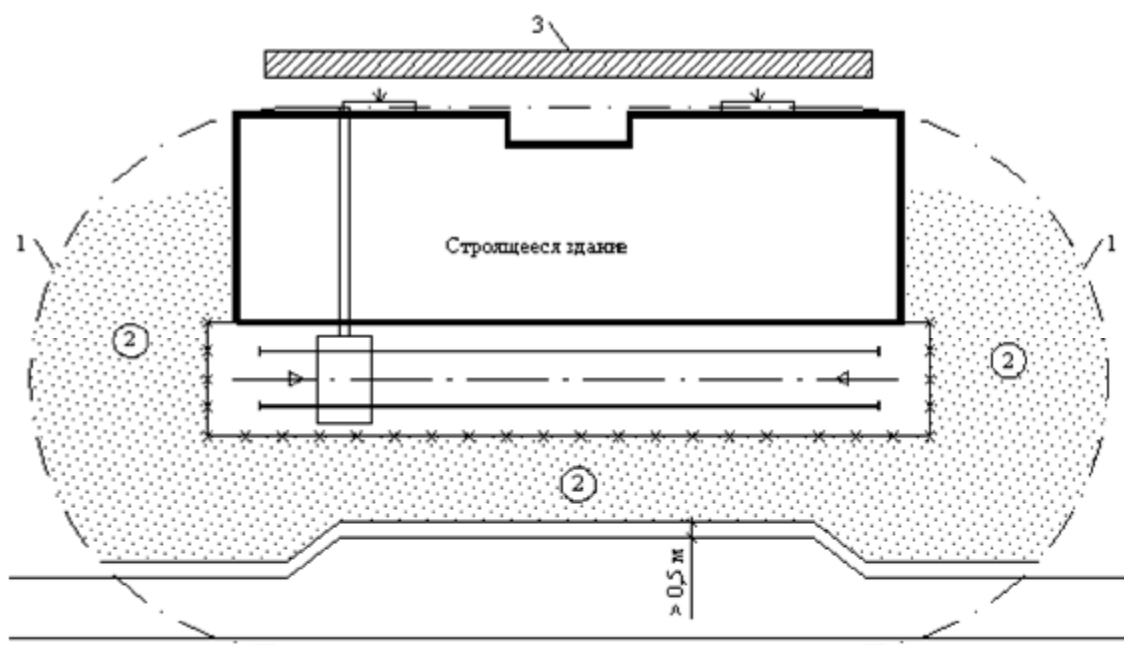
Зоны возможного расположения складов на строительной площадке
